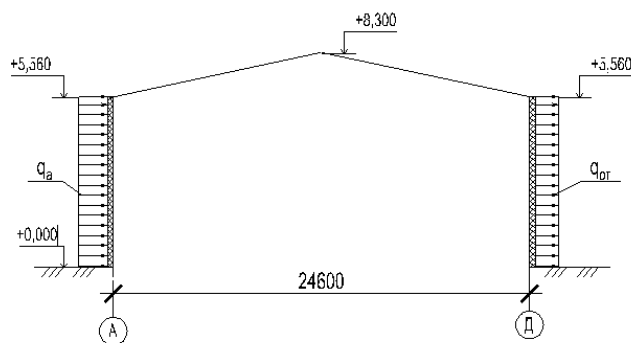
Схема приложения ветровой нагрузки на раму.
